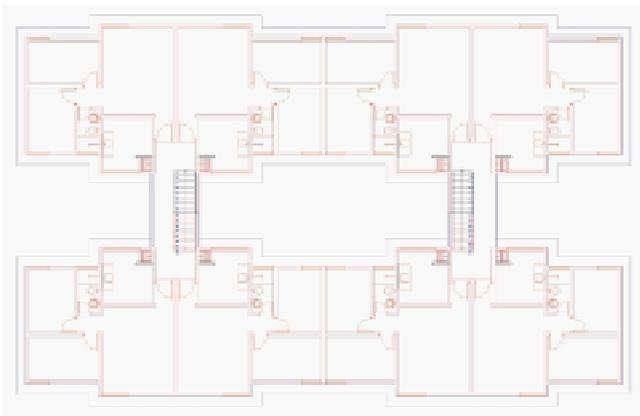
Corte horizontal (planta baixa) com indicação das partes da construção.
